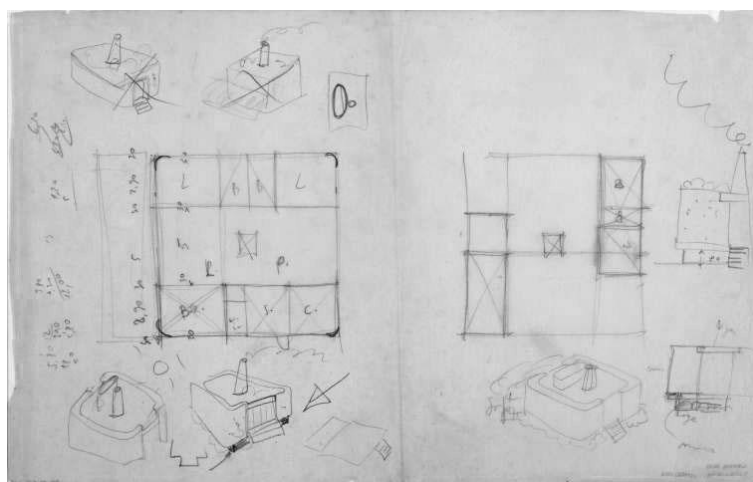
Casa Cirell. Projeto de Lina Bo Bardi, 1958. A planta quadrada.
